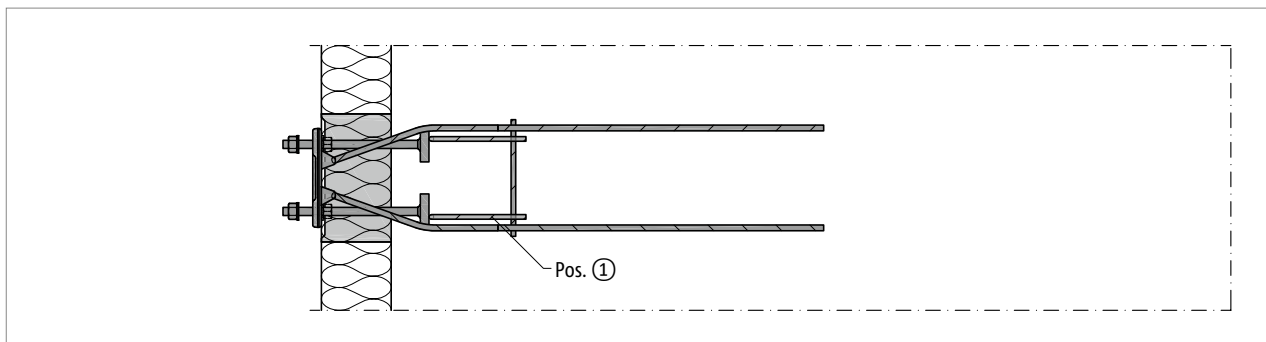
Schöck Isokorb® XT Typ SQP: Bauseitige Bewehrung, Grundriss
